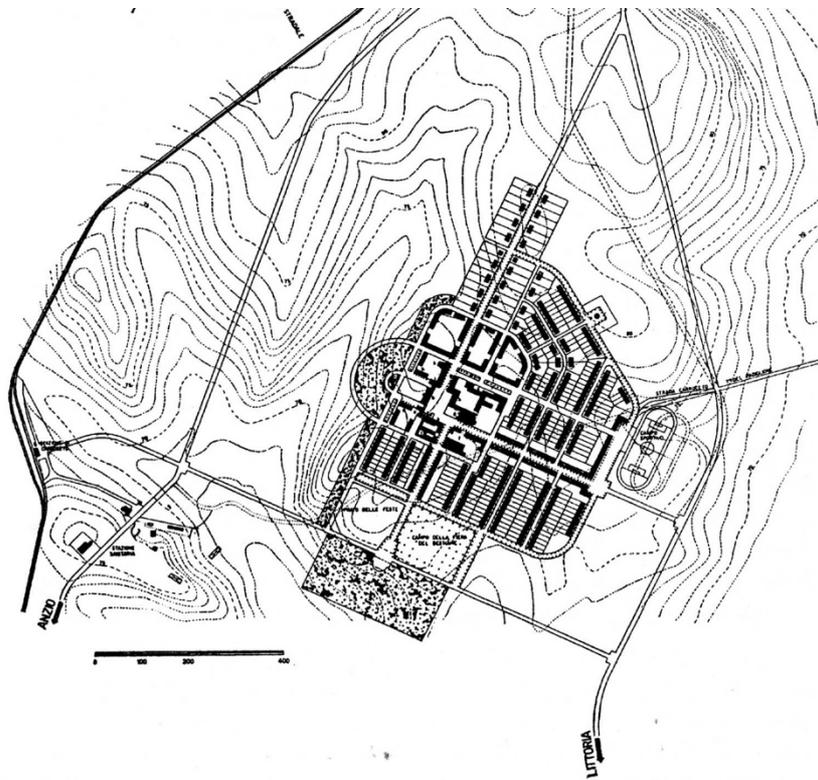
Il piano di fondazione di Aprilia (progettisti archh. C. Petrucci e M. Tufaroli e ingg. F. Paolini e R. Silenzi, 1936)
